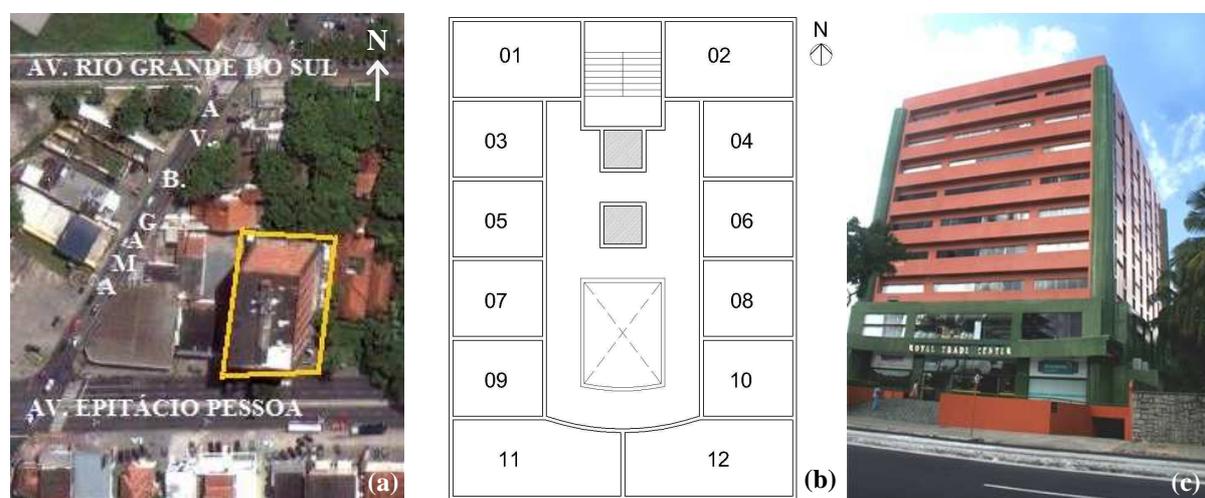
Royal Trade Center: imagem aérea (a) (GOOGLE EARTH, 2011), croqui do pavimento tipo (b) e vista sudeste (c) (META, 2008).
